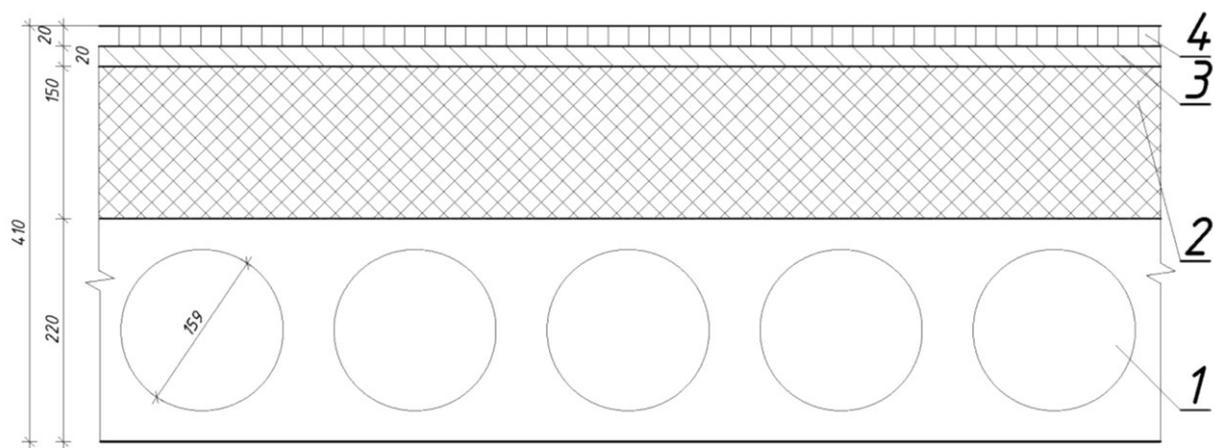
Конструкція перекриття над неопалювальним підвалом
